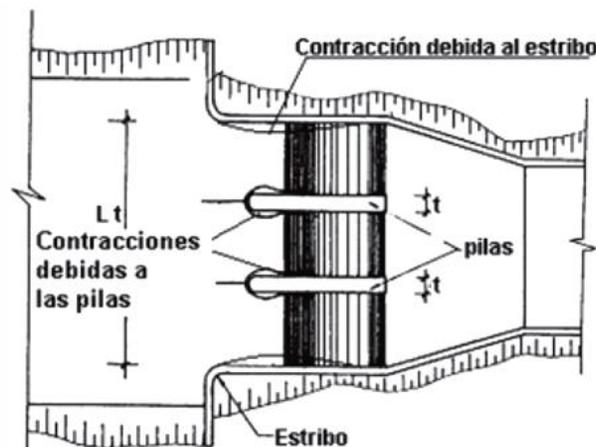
Esquema de contracciones del flujo producido a la presencia de pilas y estribos.
